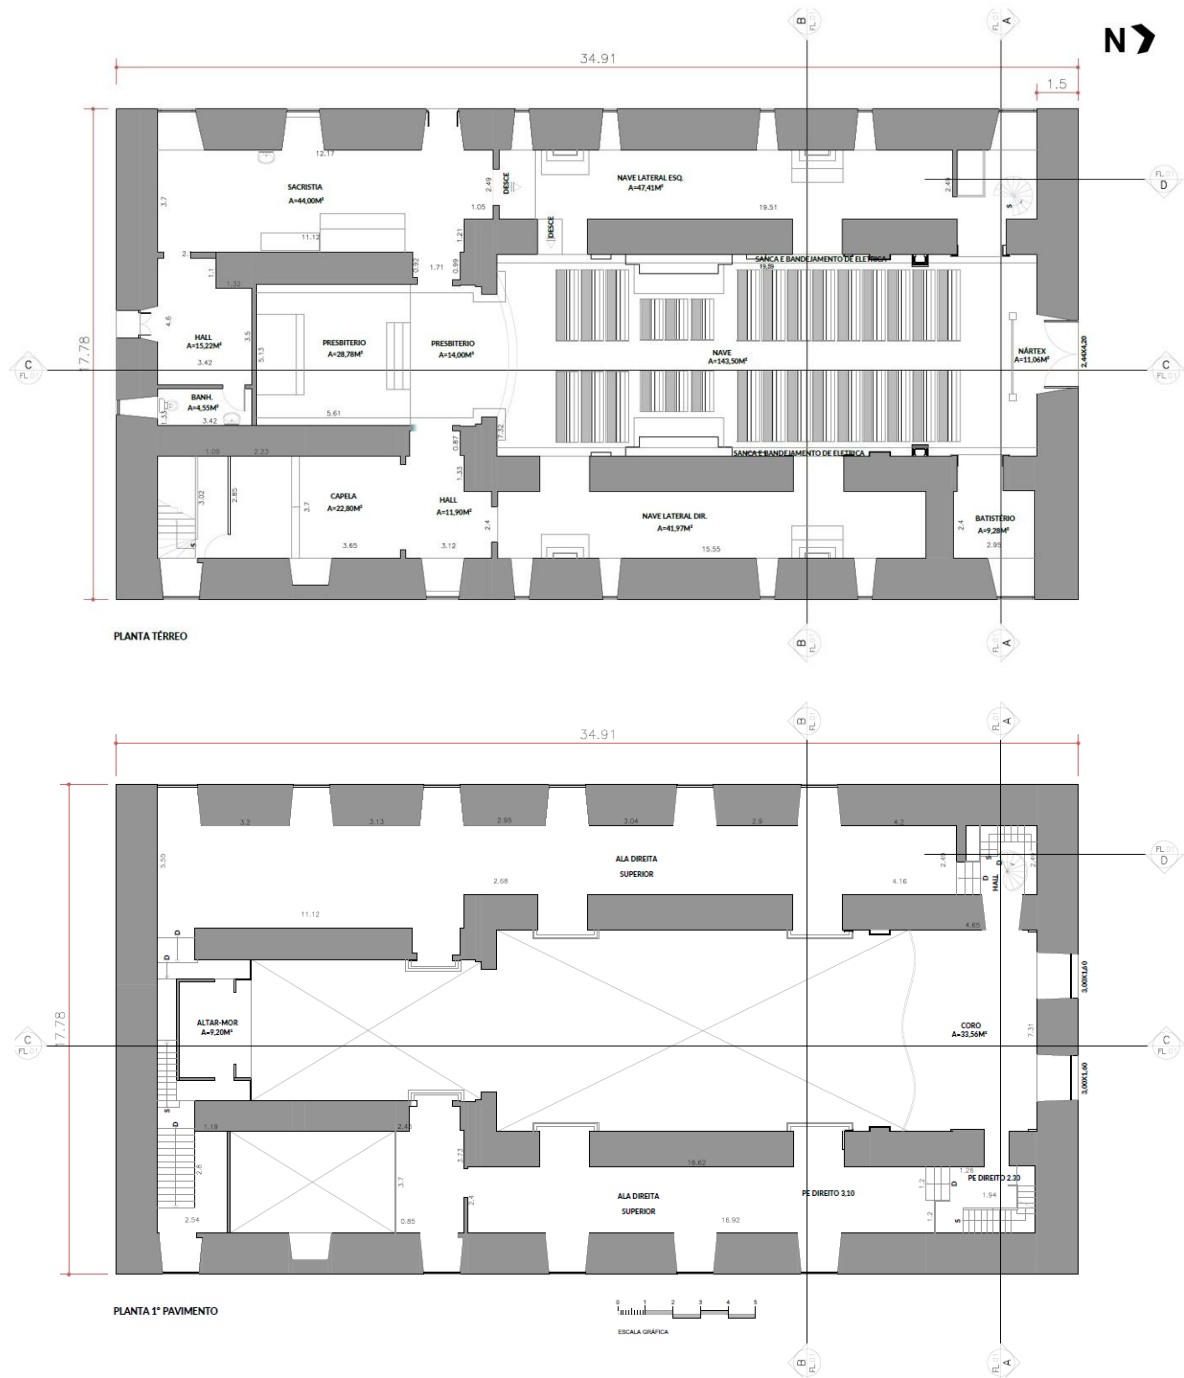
Levantamento cadastral da Igreja Sant'Ana – plantas baixa térreo e 1º pavimento.
